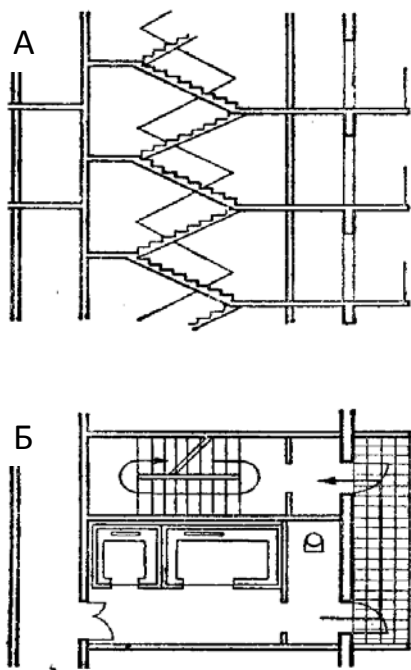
устройство незадымляемой лестницы с использованием наружных открытых площадок: А-разрез; Б-план
